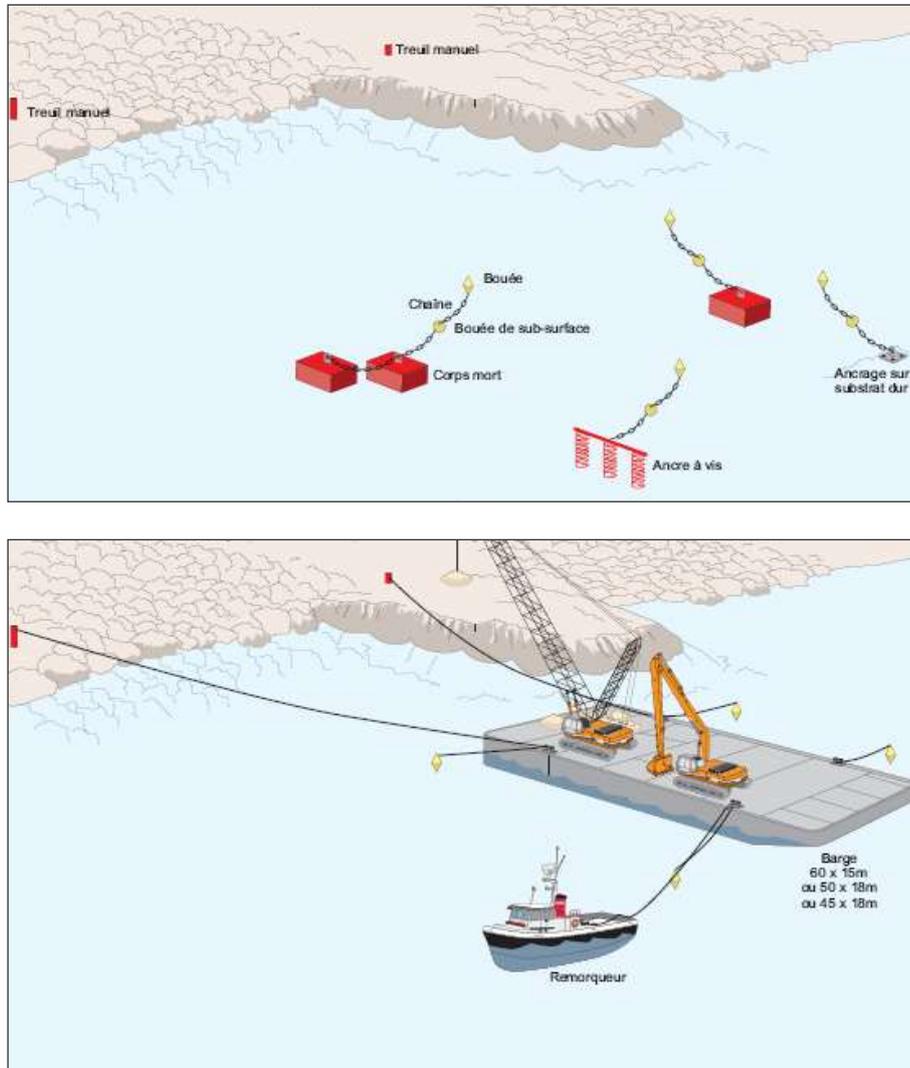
schémas de principe des dispositifs d'amarrage d'un ponton-barge.
